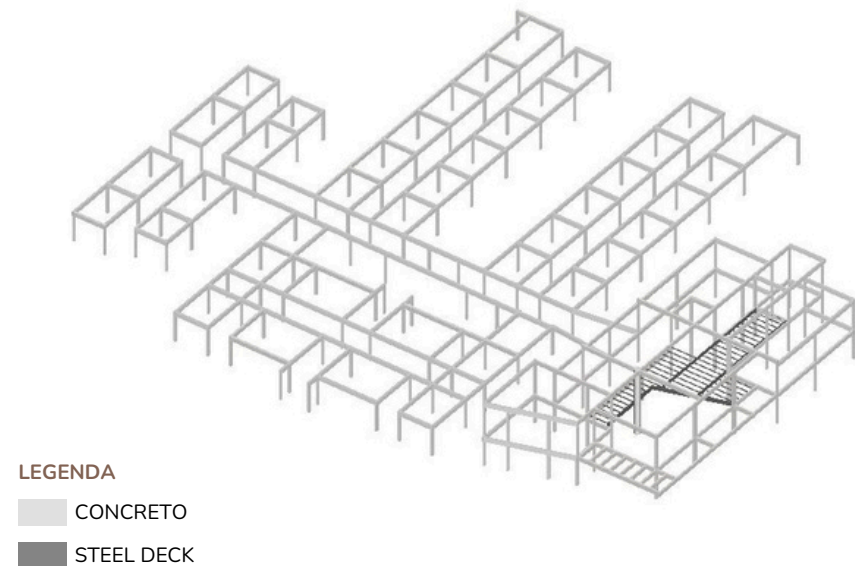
Esquema estrutural de pilares e vigas. Elaborado pela autora.
